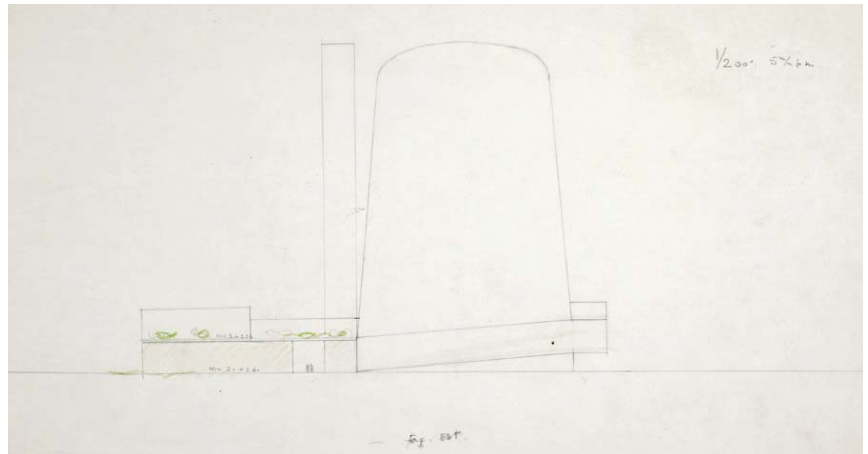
Dibujo variante de la fachada este. Primera versión. Fuente: FLC. 16650
